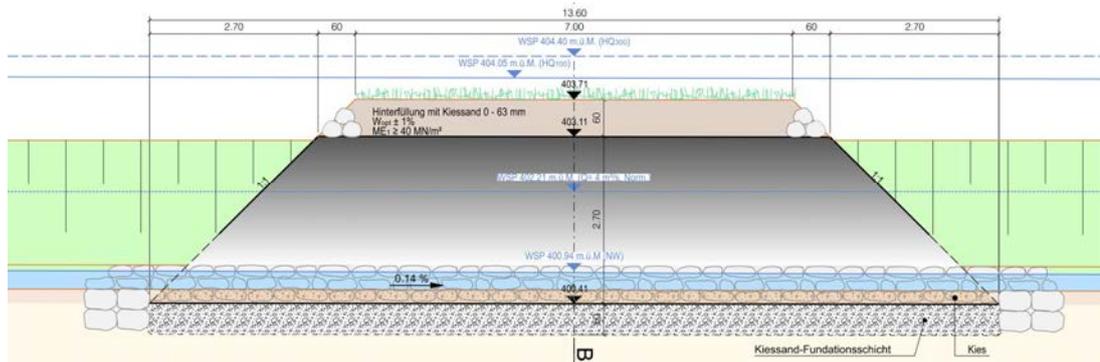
Längsschnitt Durchlass «Schlatt», Buechholzbach
